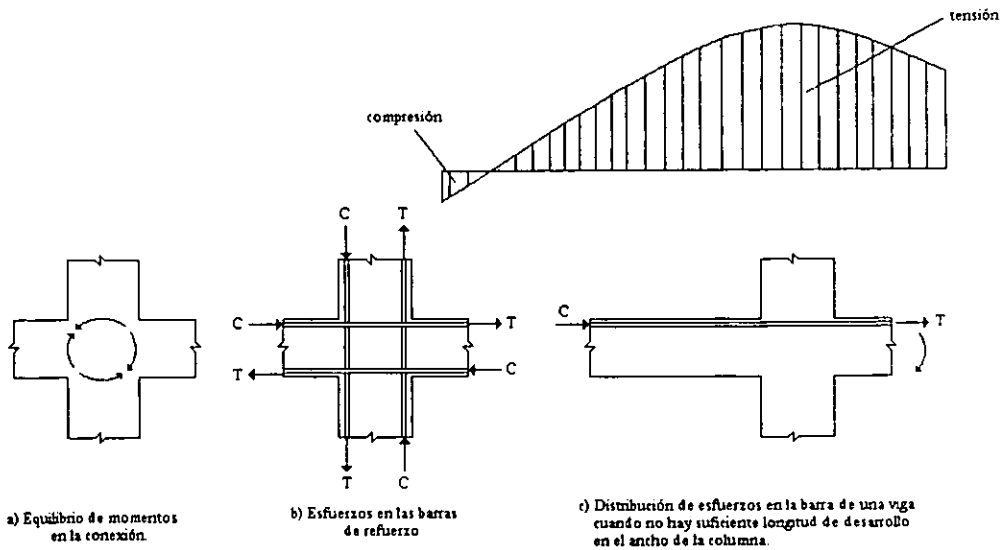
Estado de esfuerzos en una conexión viga-columna interior.
